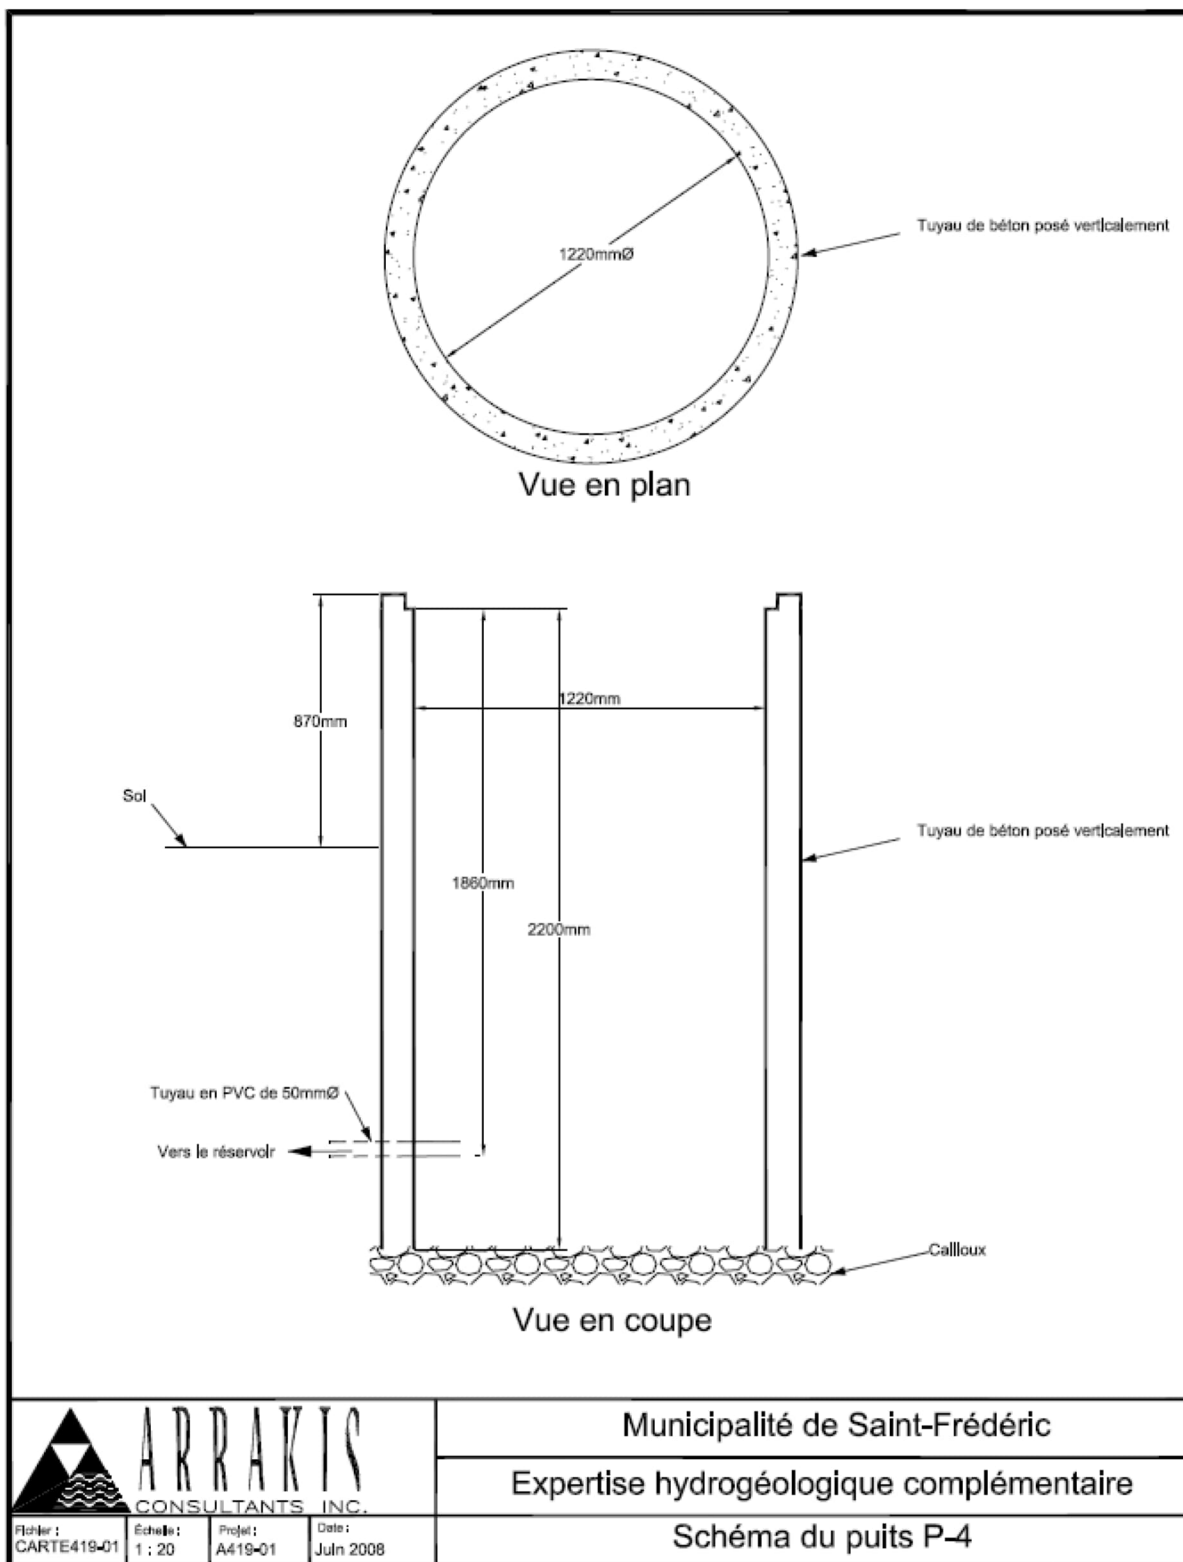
Vue en coupe de la construction de l'installation de prélèvement X2002616-1 (Puits P-4)
